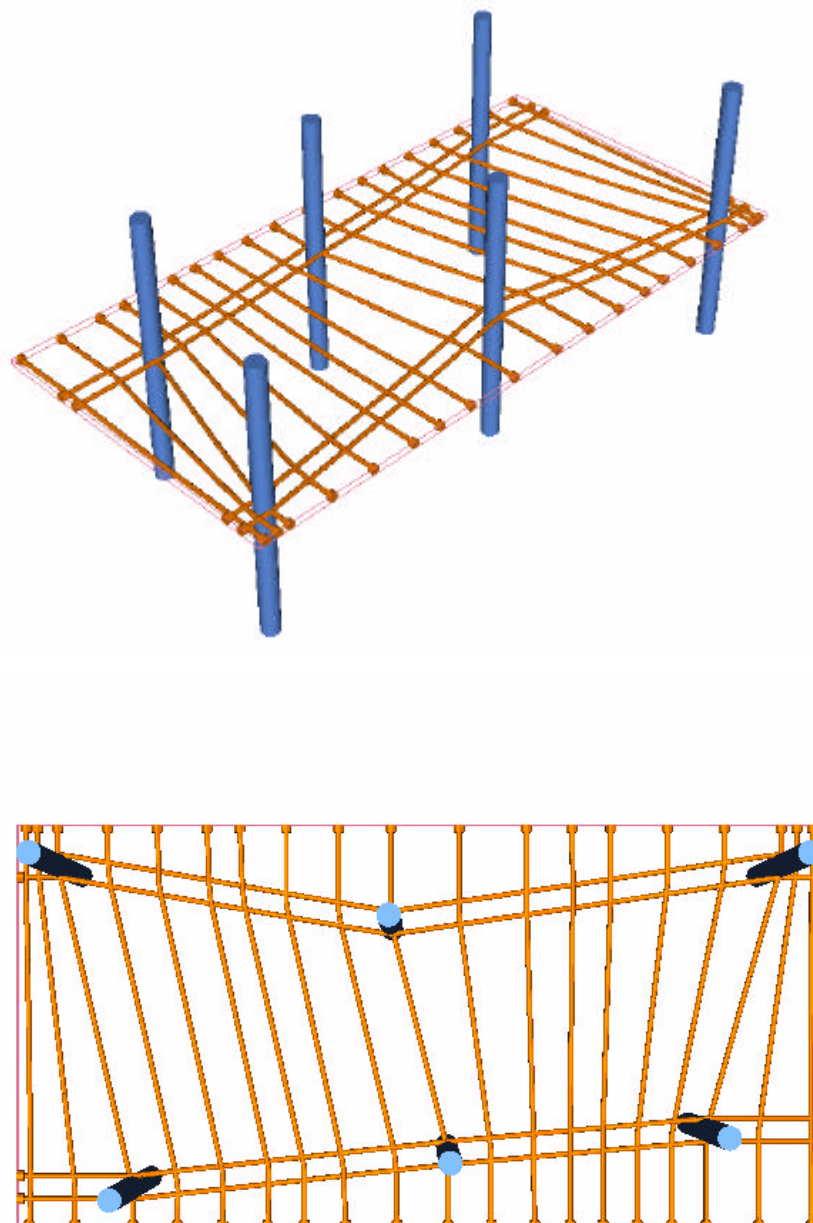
Cabos em Vista Tridimensional e em Planta
